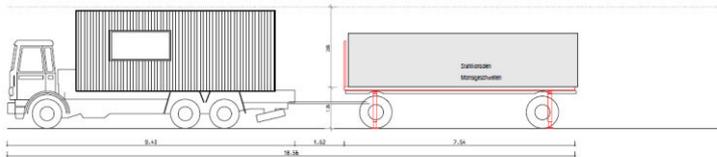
Montageplan (Projekt A)⁴¹⁸
